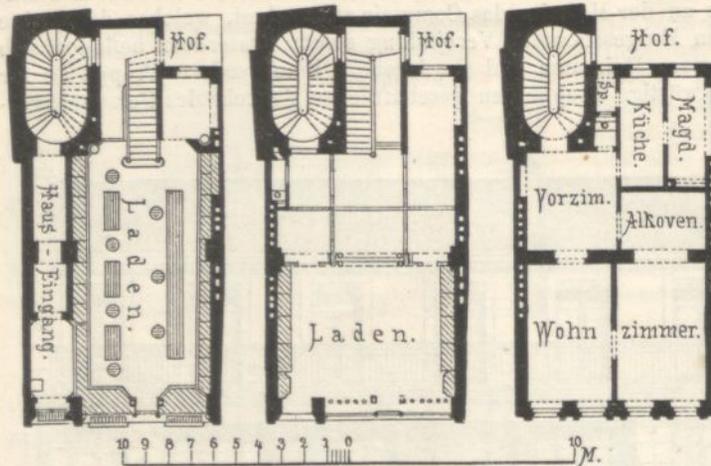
Erdgeschoss. Fig. 592. Mezzanin. Fig. 593. Obergeschosse.
